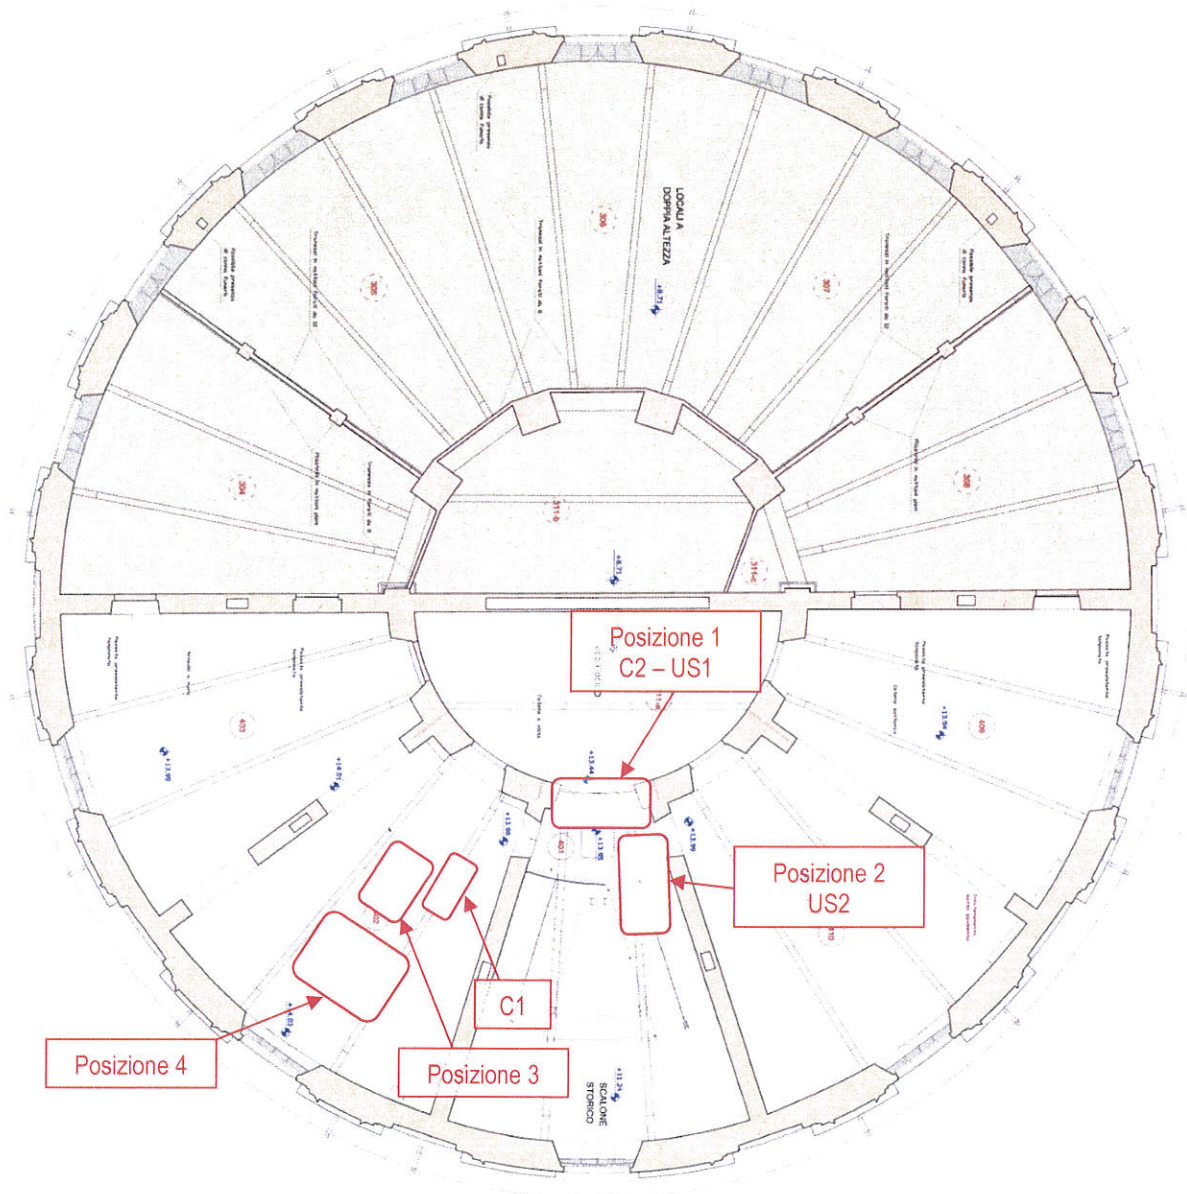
Piano secondo – posizione dei rilievi dell'armatura, delle prove ultrasoniche e dei prelievi di calcestruzzo
